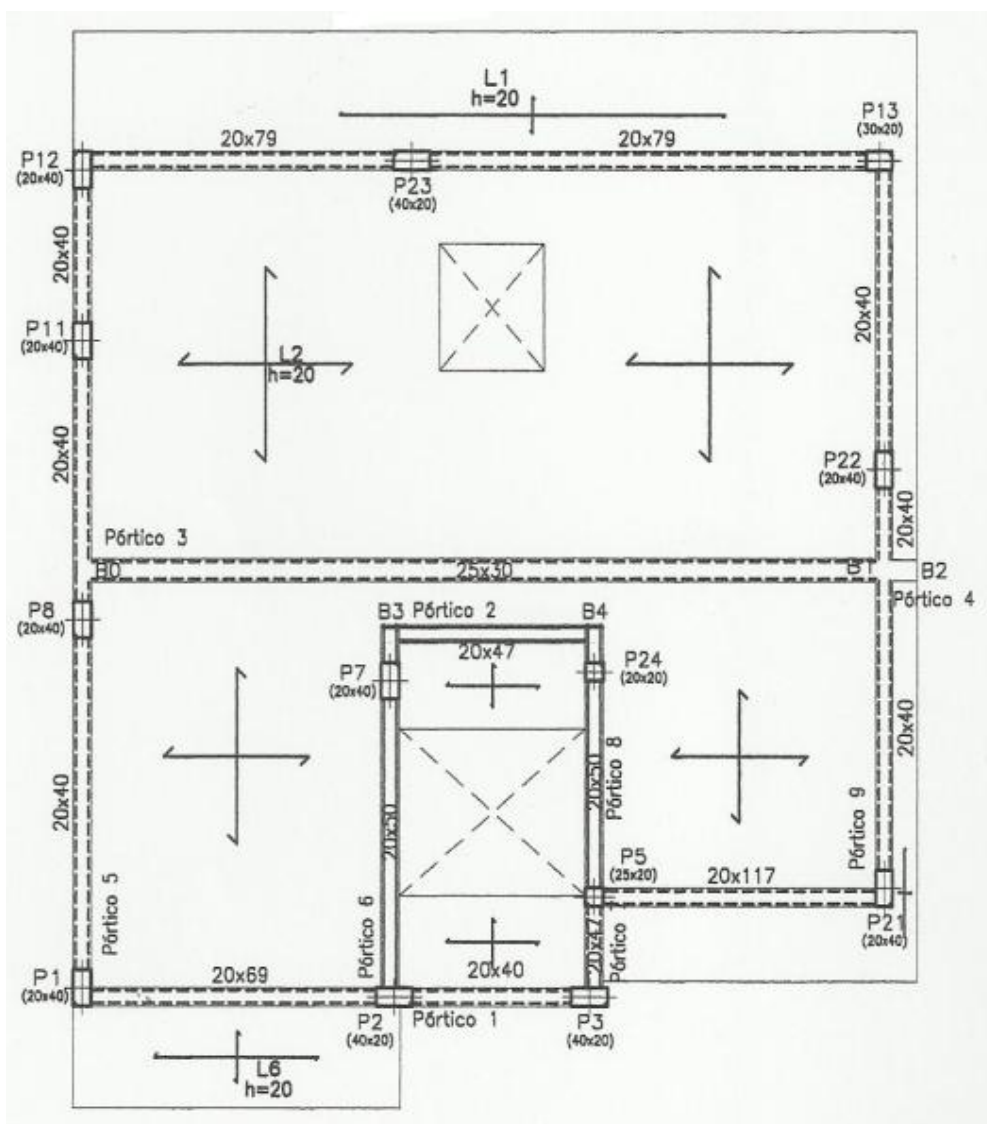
Projeto de Estabilidade – Planta de Cobertura
